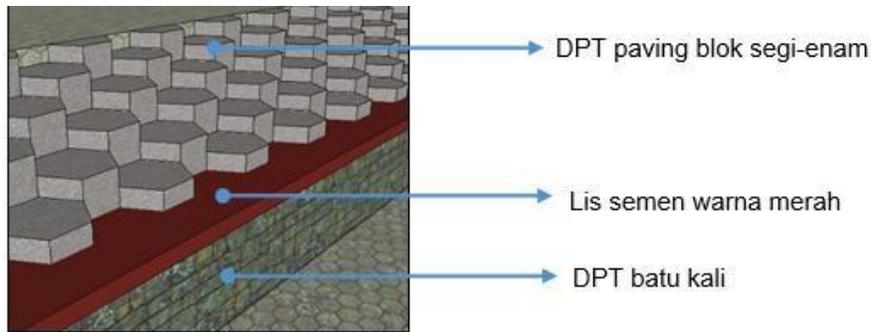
Elemen Penyusun Ruang Area Seberang Sungai
